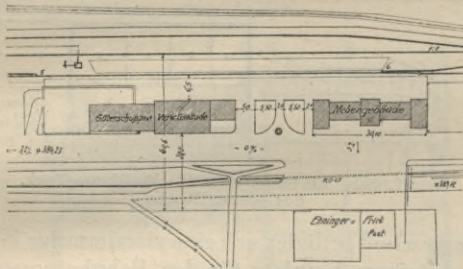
M. = 1:2000. Empfangsgebäude Weilheim/Teck. Lageplan.
